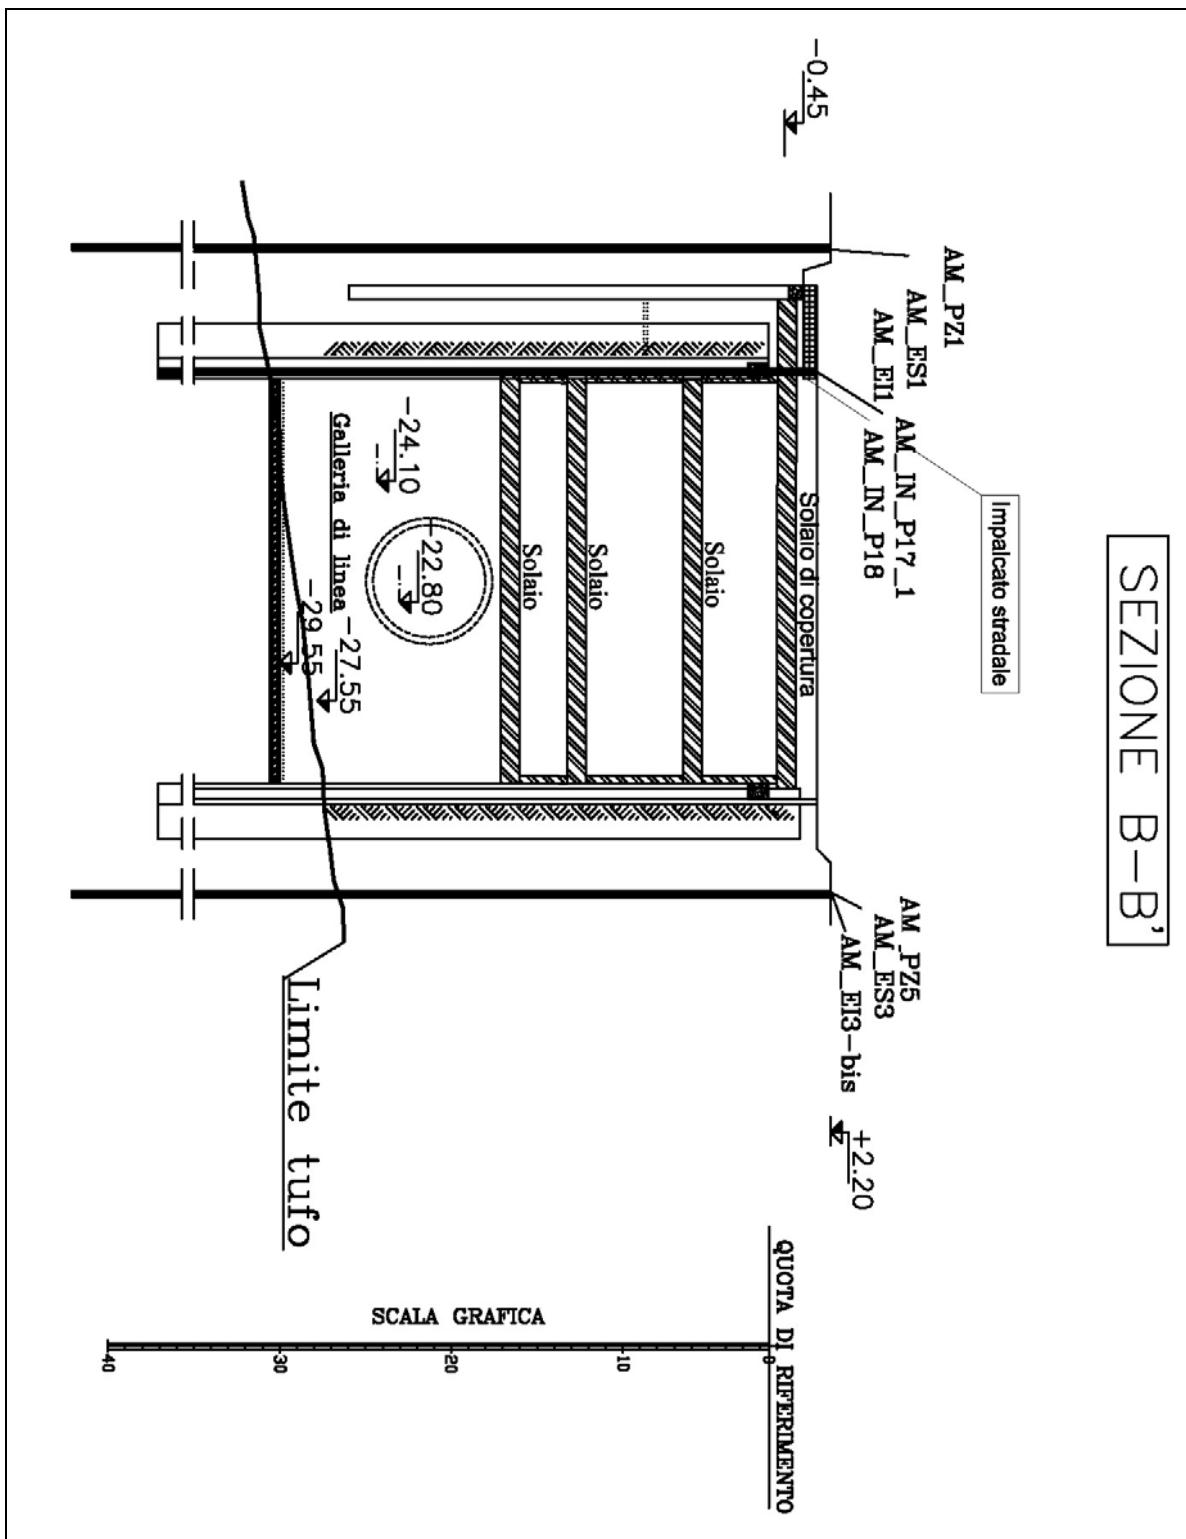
Sezione B-B' pozzo stazione, raffigurante la suddivisione in aree di lavoro.
